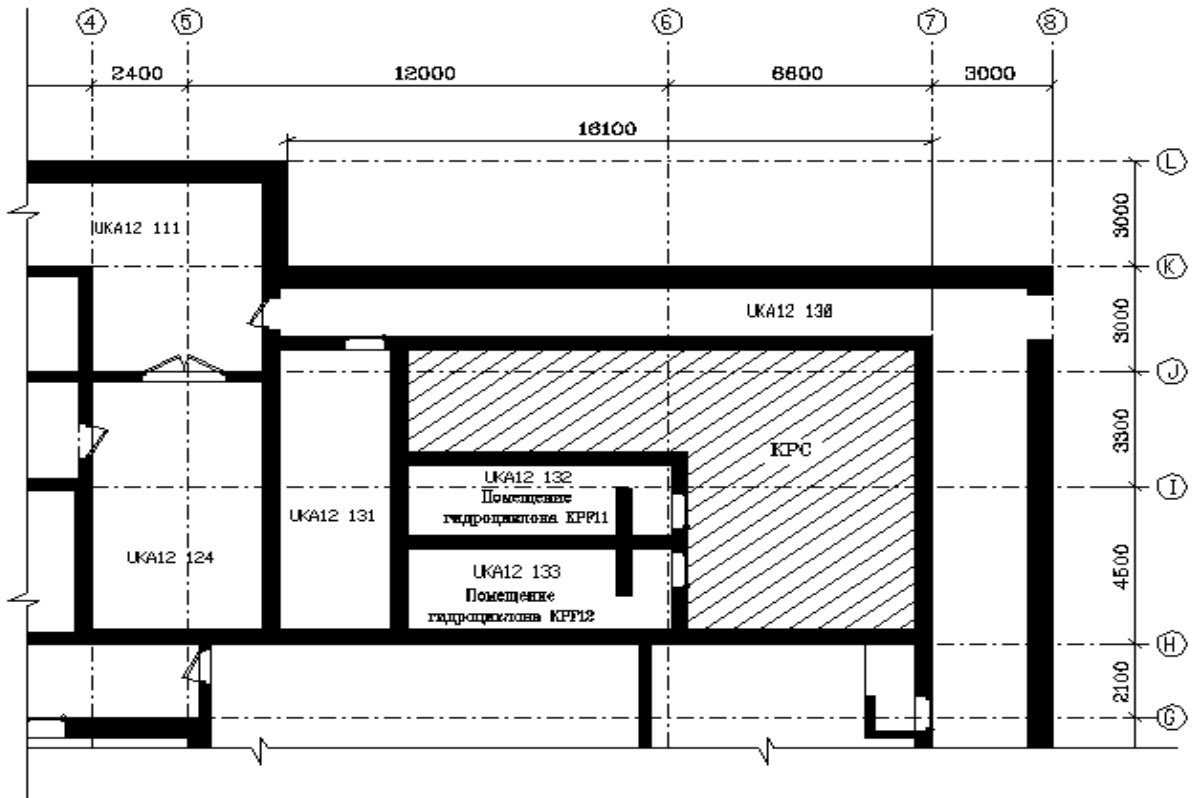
Фрагмент плана вспомогательного корпуса (УКА) для расположения оборудования установки отверждения на отм.+12,000
